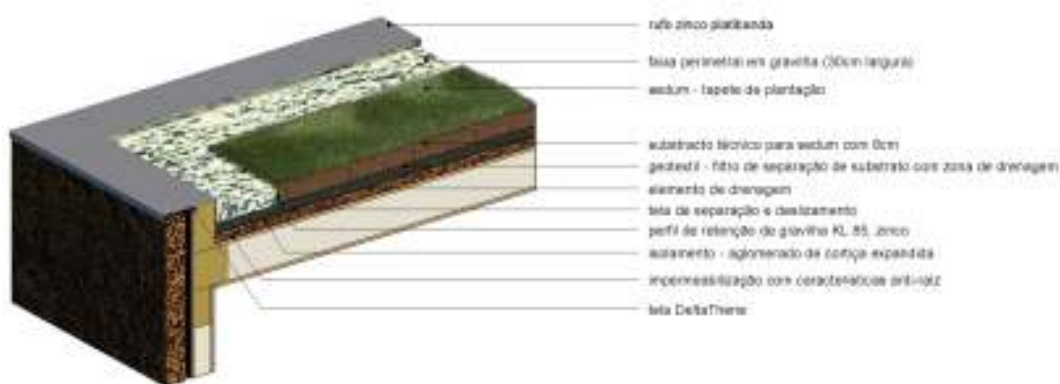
Pormenor construtivo da cobertura ajardinada.
